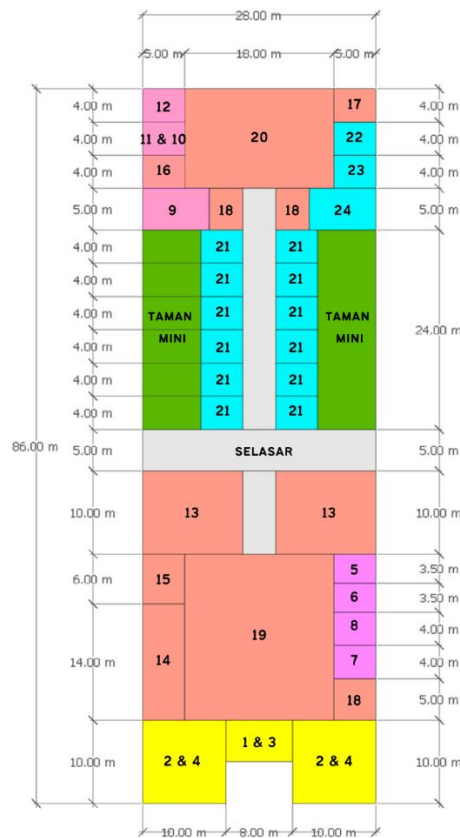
14 Ruang Terbuka pada Massa Bangunan
